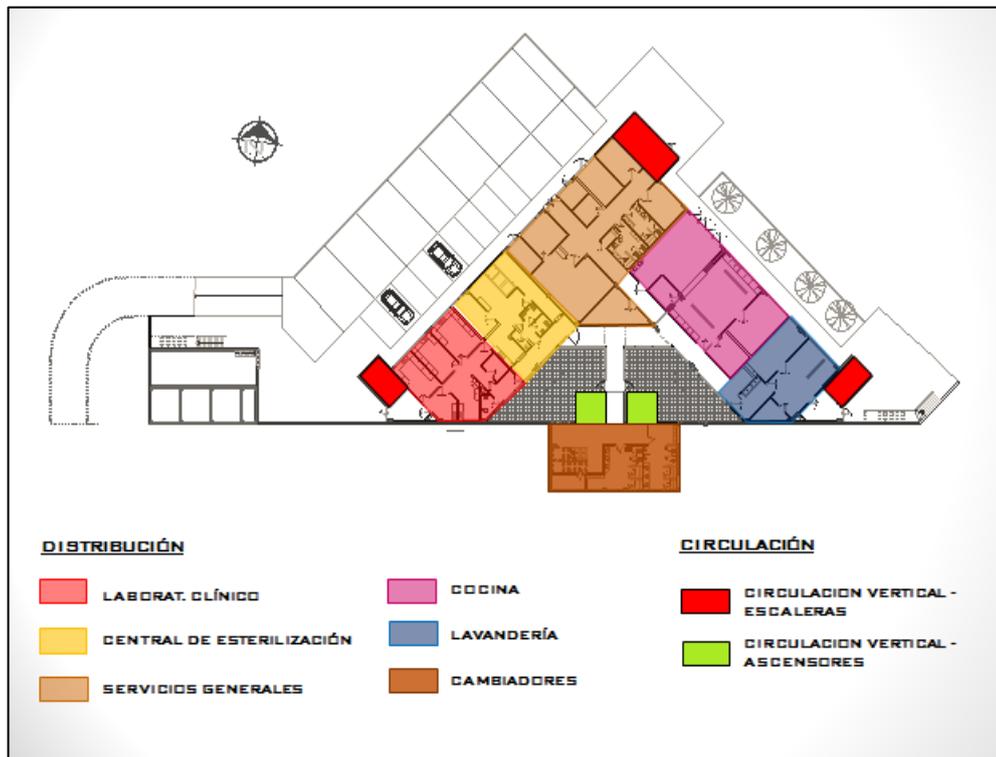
Plano Planta Baja Hospital II-1 Cajabamba
